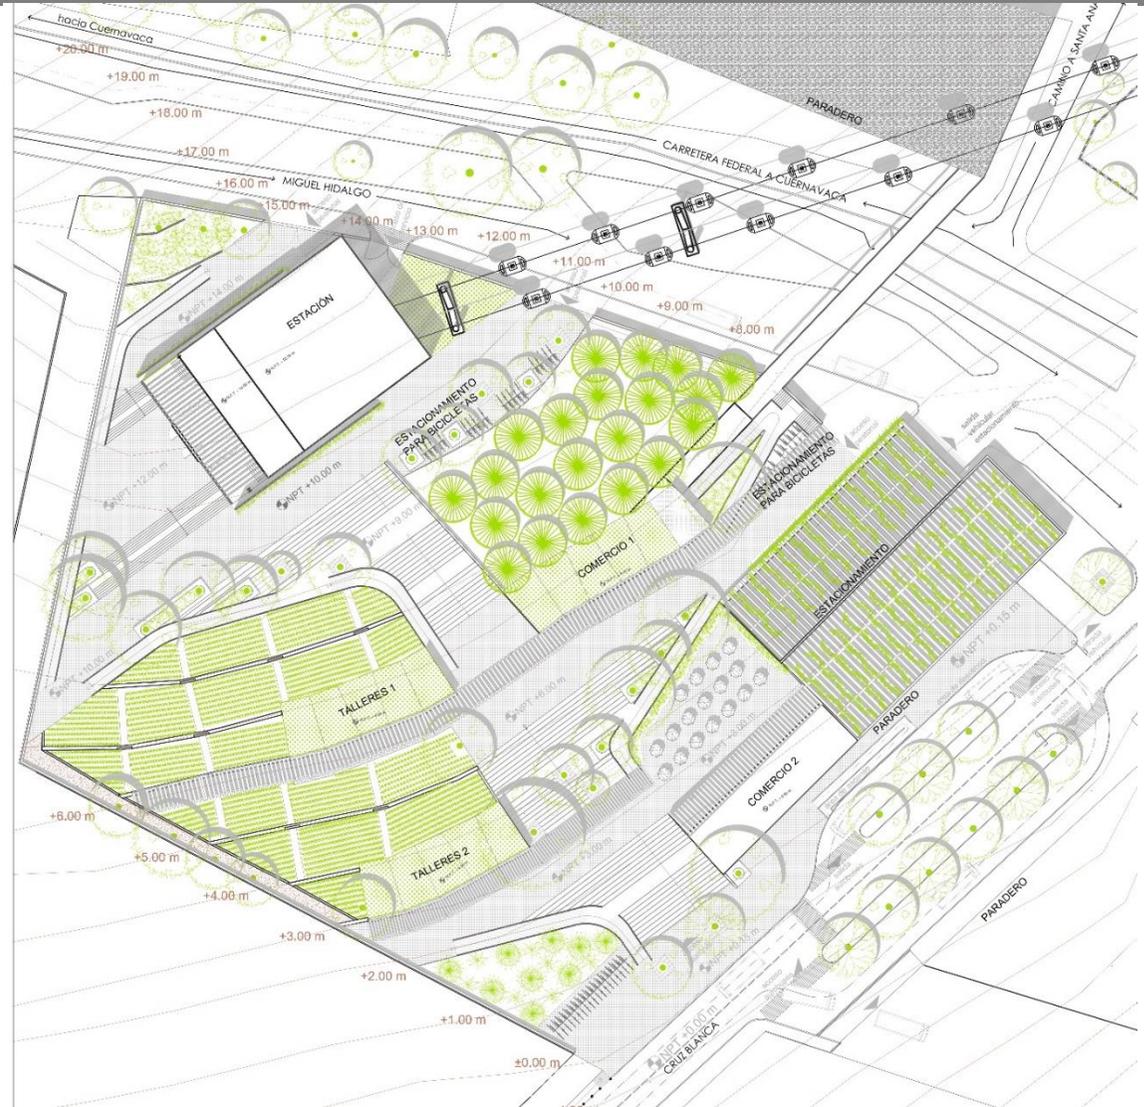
Planta de conjunto. Ver en Anexo
